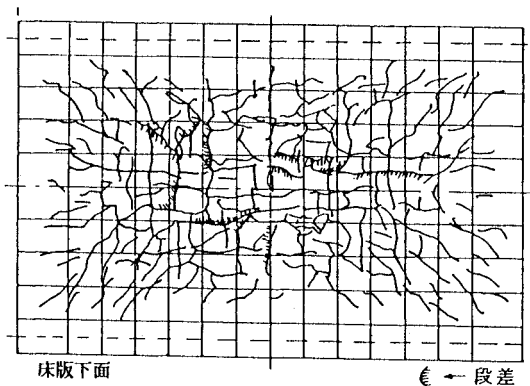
床版下面のひびわれ発生状況 (供試体 A-1)
